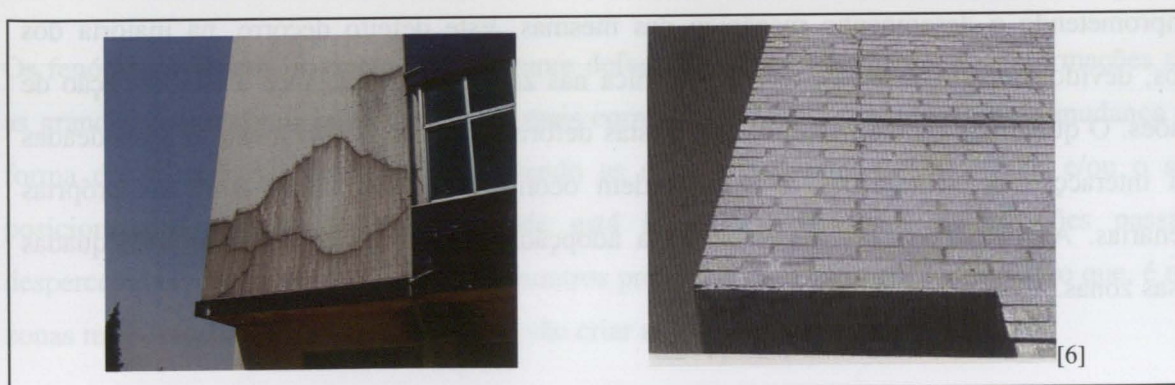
Fissuração verificada na zona da parede apoiada em laje em consola
